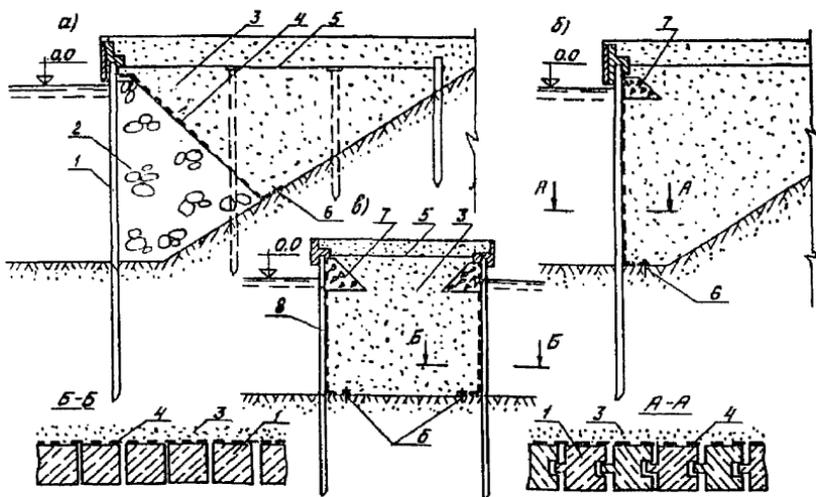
Схема причальной набережной типа "больверк": а - с разгружающей каменной призмой; б - без каменной призмы; в - pier из свайного частотола; 1 - лицевая стенка из плоского железобетонного шпунта; 2 - каменная призма; 3 - обратная песчаная засыпка; 4 - геотекстиль; 5 - анкерная тяга; 6 - металлические скобы или нагели; 7 - щебеночная призма; 8 - свайный частотокол
